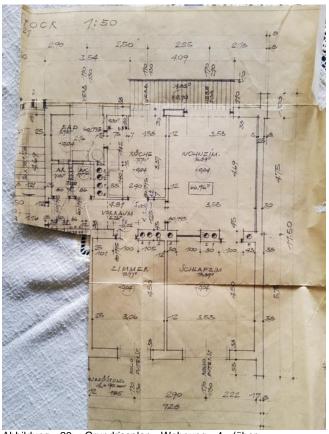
Grundrissplan Wohnung 4 (über Wohnung 1); Quelle: von Bewohnerin Wohnung 4 zur Verfügung gestellt
